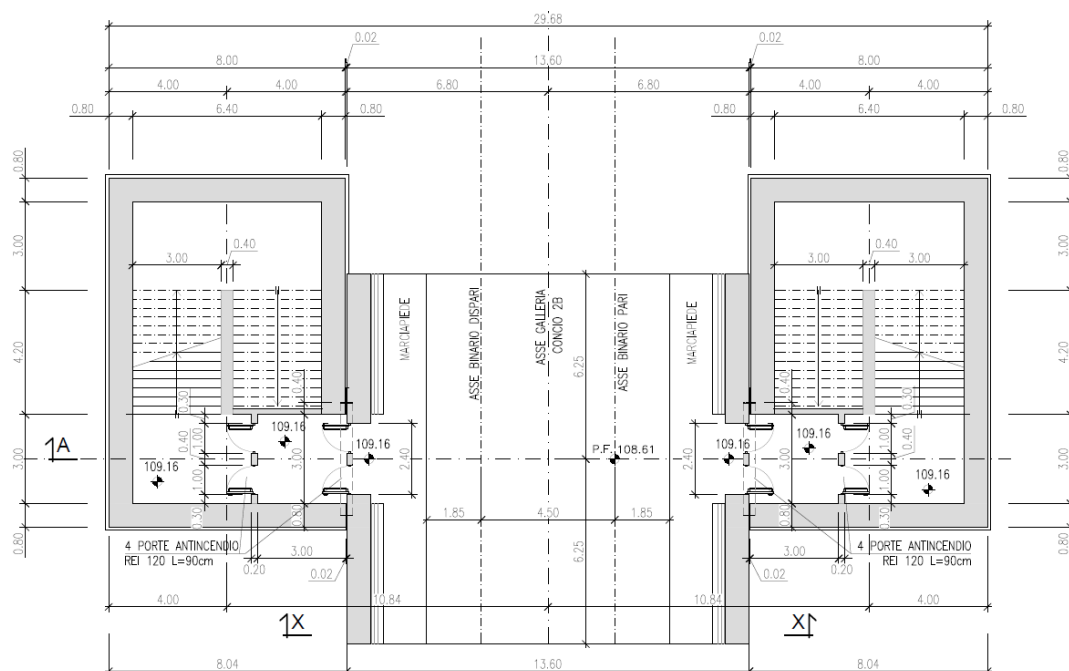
Sezione in pianta dell'uscita di emergenza alla pk 141+982.97
